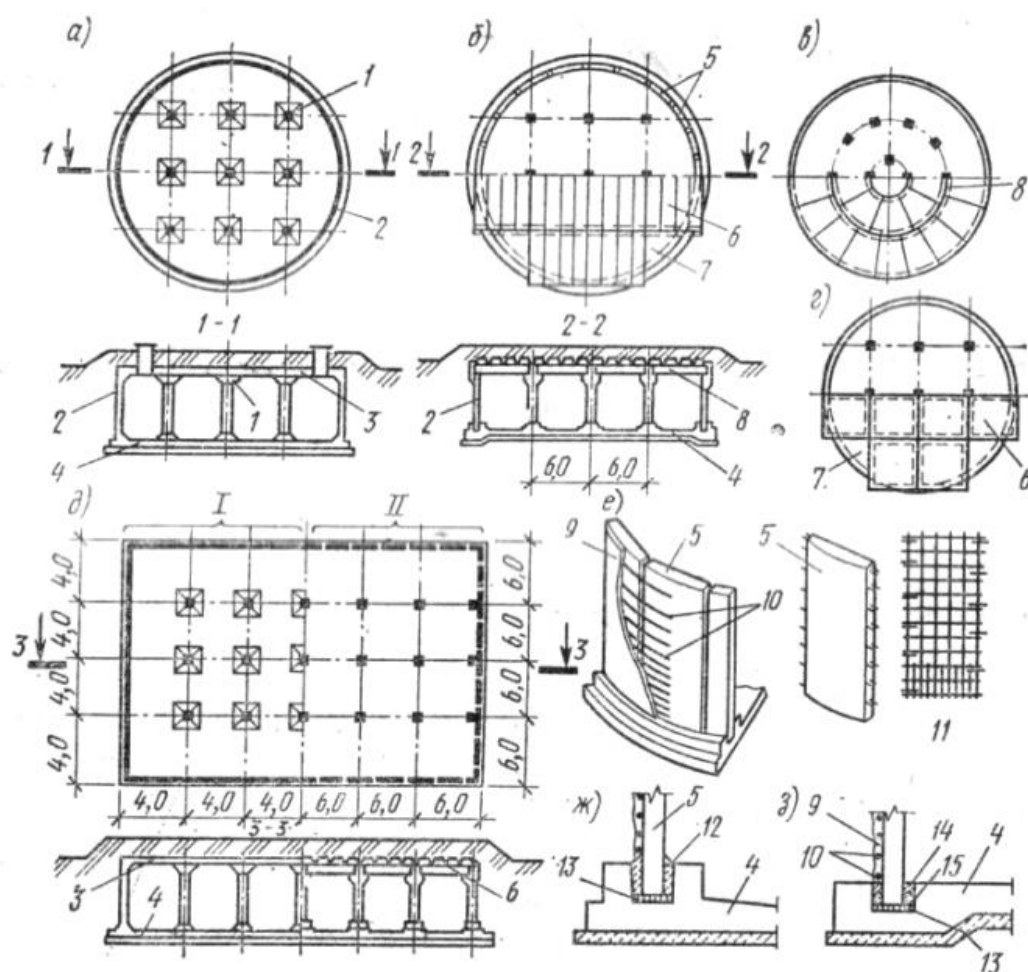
Конструкции железобетонных резервуаров (размеры в м):
